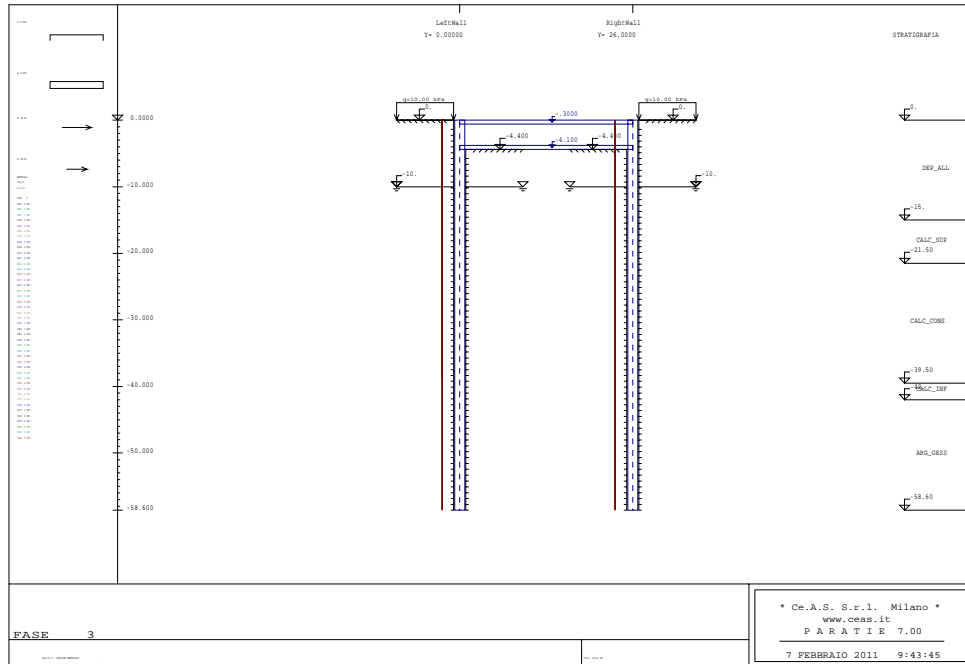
Fase 3: Getto solaio a +63.51m s.l.m.
